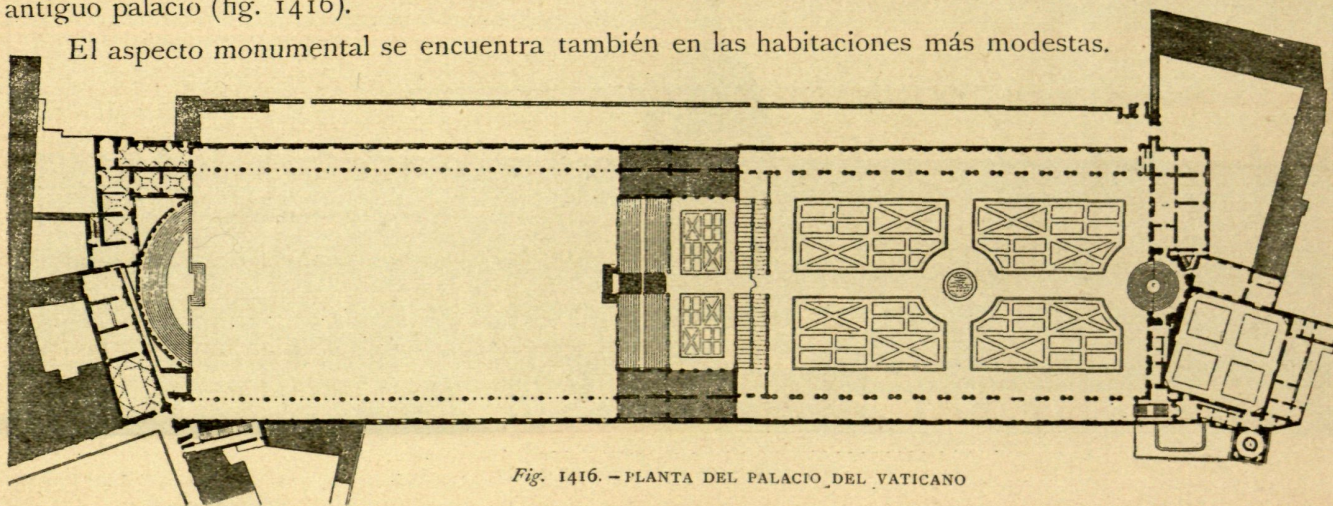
PLANTA DEL PALACIO DEL VATICANO
